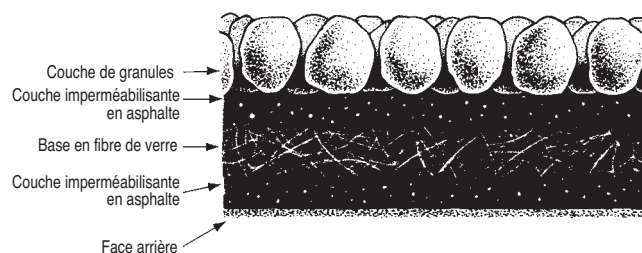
Vue en section d'un bardeau en fibre de verre
